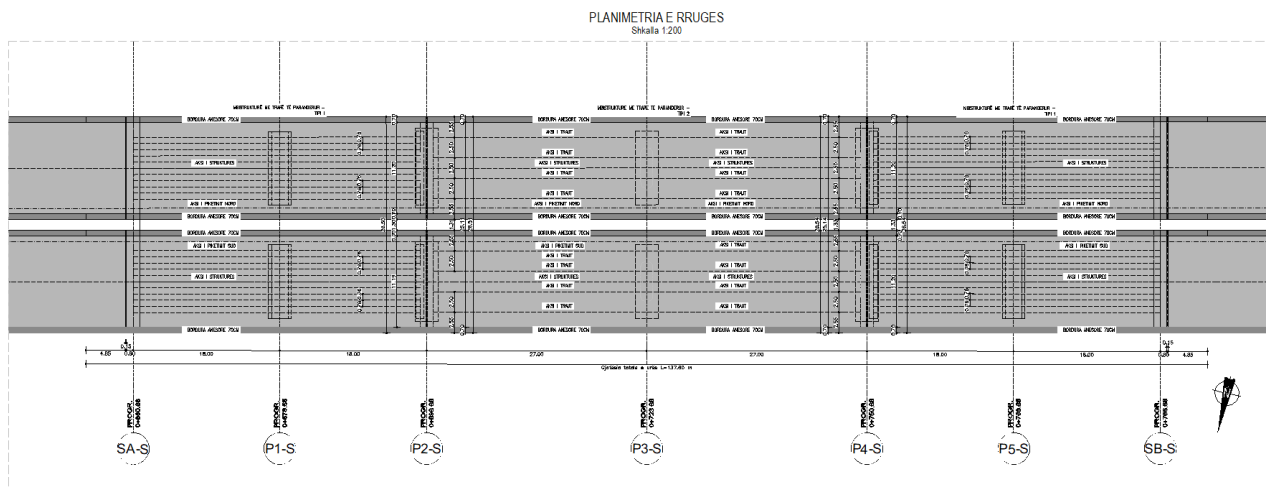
Planimetria e Viaduktit me trare te paranderur
